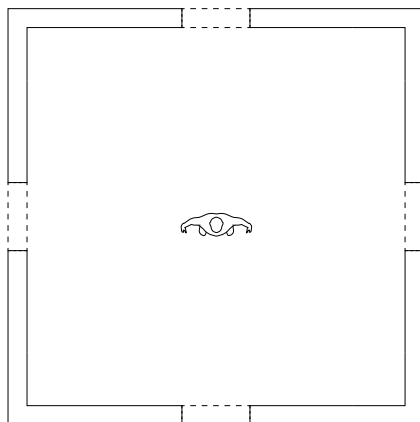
Pos. I.I | Grundriss – M.1:100
